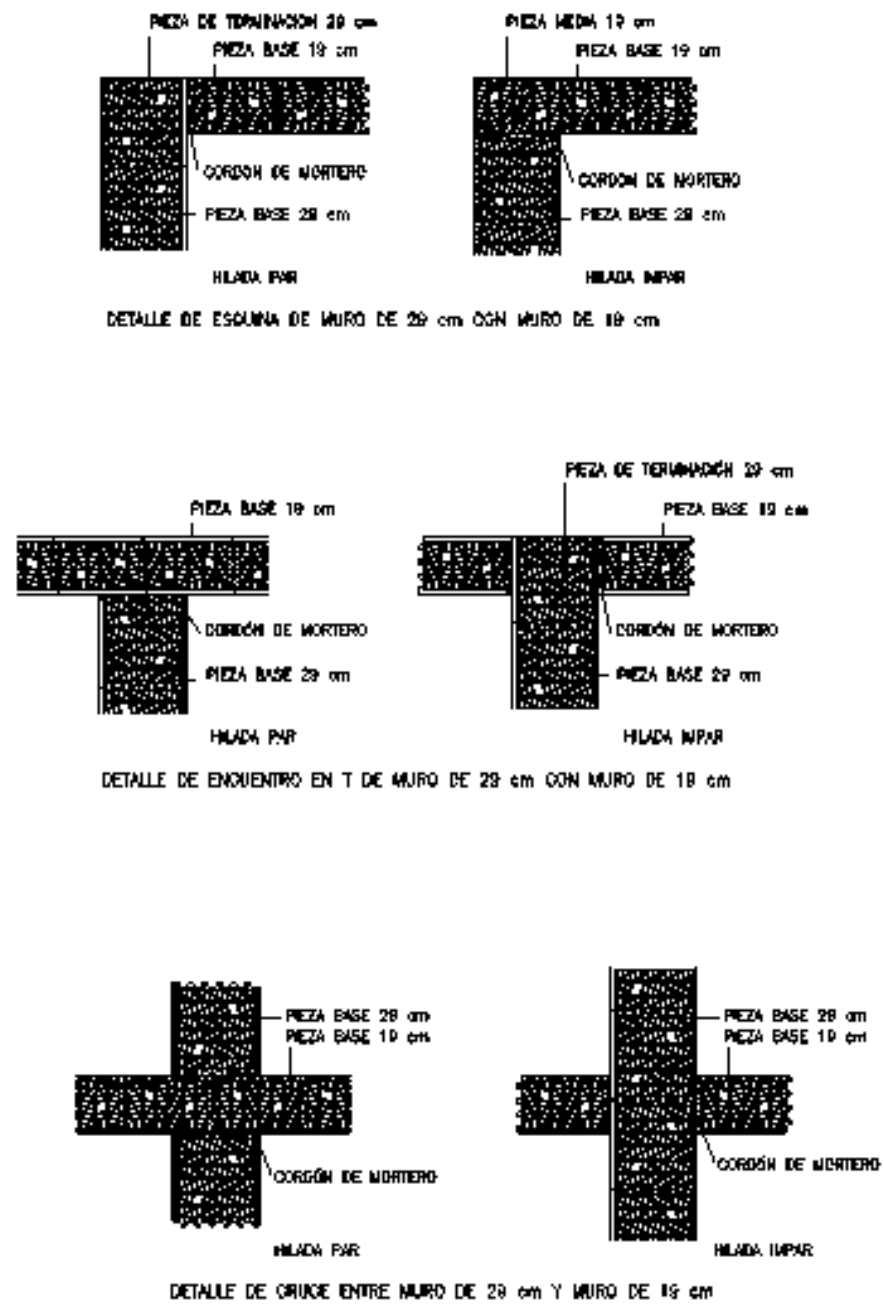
Detalles de encuentro de piezas de 29 cm con piezas de 19 cm.
